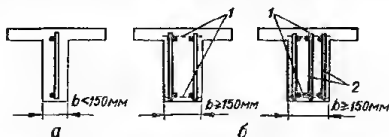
Армирование балок плоскими сварными каркасами;
